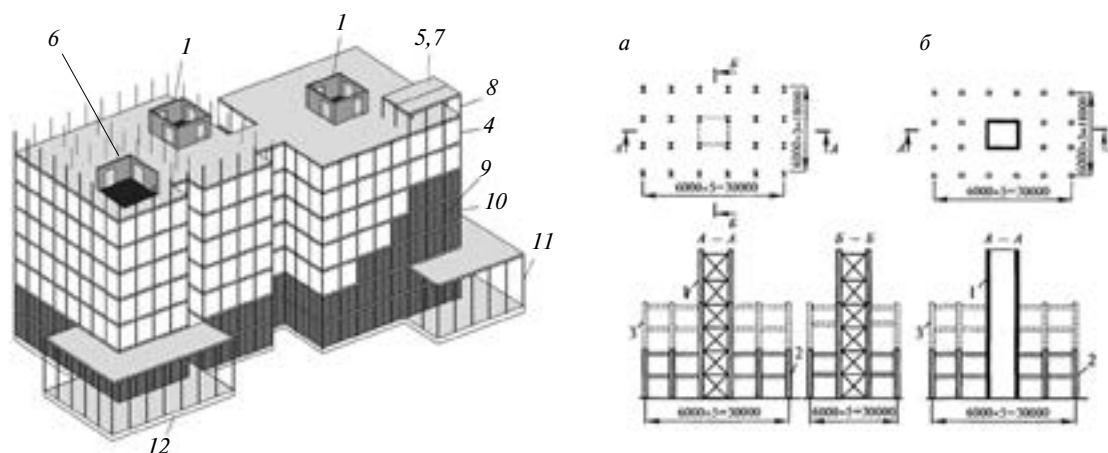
Схема возведения каркаса высотных зданий из строительных модулей с ограждающими сэндвич-панелями и остеклением: а — со стальным ядром жесткости; б — с железобетонным каркасом; 1 — ядро жесткости; 2 — смонтированная часть каркаса; 3 — монтируемая часть каркаса; 4 — строительный модуль; 5 — пол; 6 — несущие стены; 7 — строительный потолок; 8 — одноуровневые несущие колонны; 9 — ограждающие панели; 10 — стеклопакеты; 11 — удлиненные несущие колонны; 12 — фундамент
